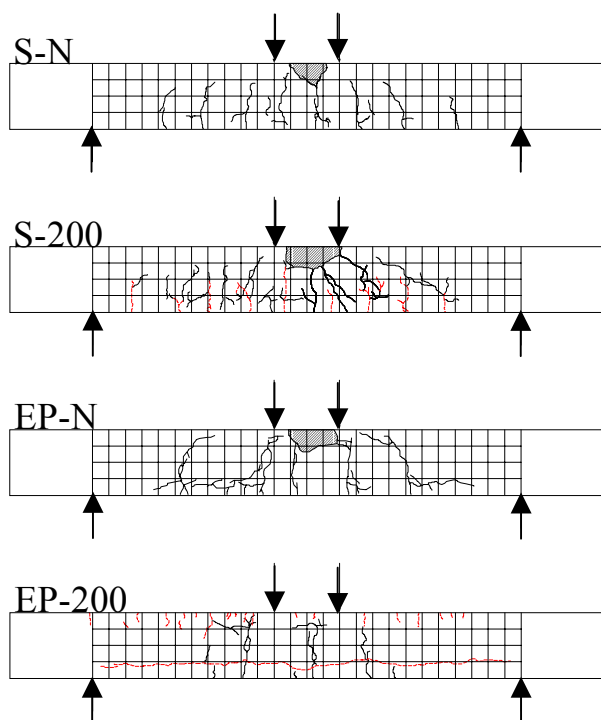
ひび割れ図 (S, A-EP シリーズ)
